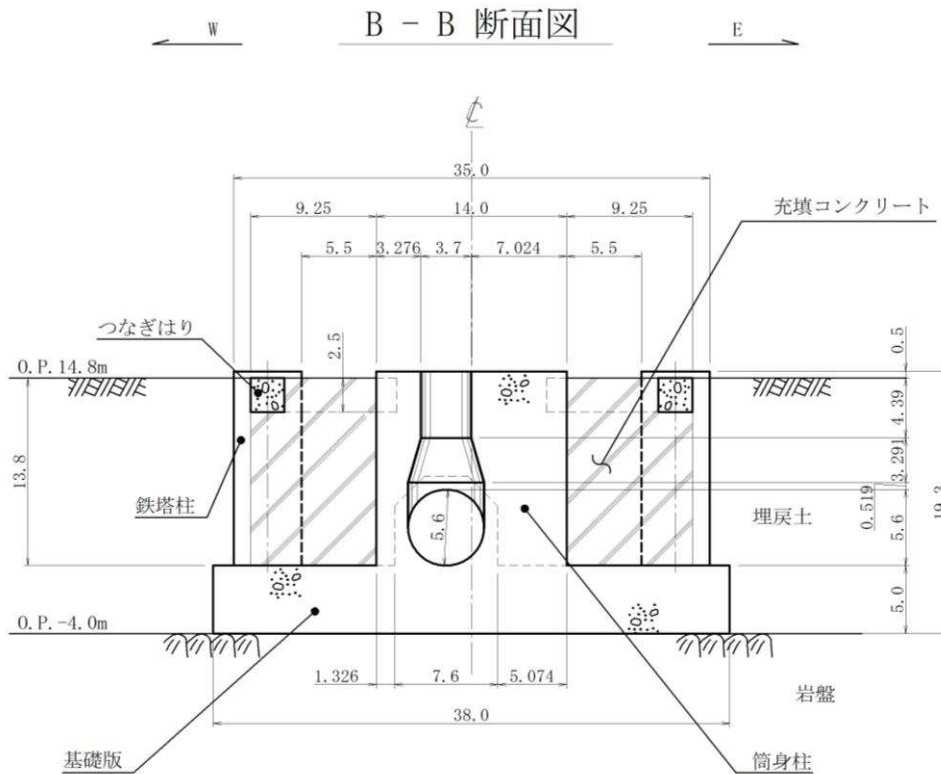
排気筒基礎断面図 (B-B 断面, EW 断面) (単位 : m)
